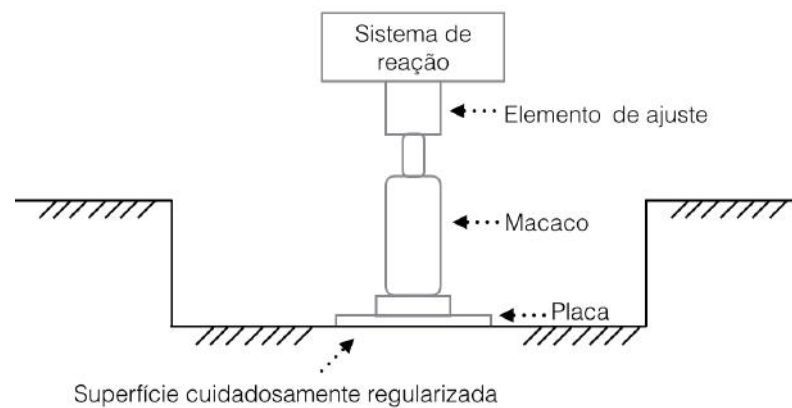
Esquema do sistema de ensaio de carga em placa
